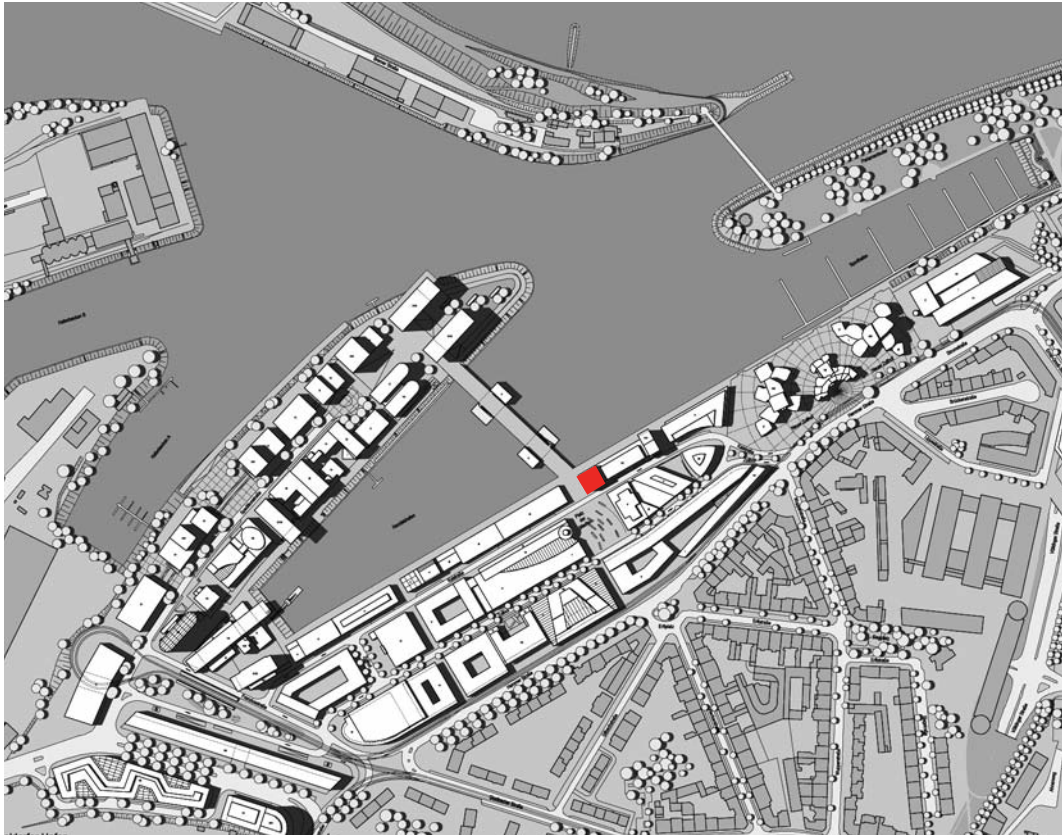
Lageplan des Medienhafens Düsseldorf (rote Markierung des Baugrundstückes für das Haus Immendorff von der Verf.).
